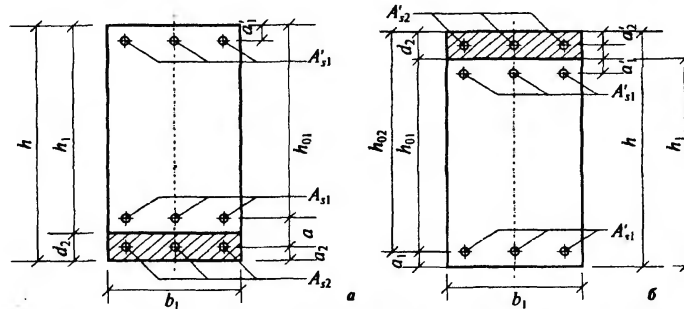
Поперечное сечение внецентренно сжатой колонны, усиливаемой дополнительной арматурой:
